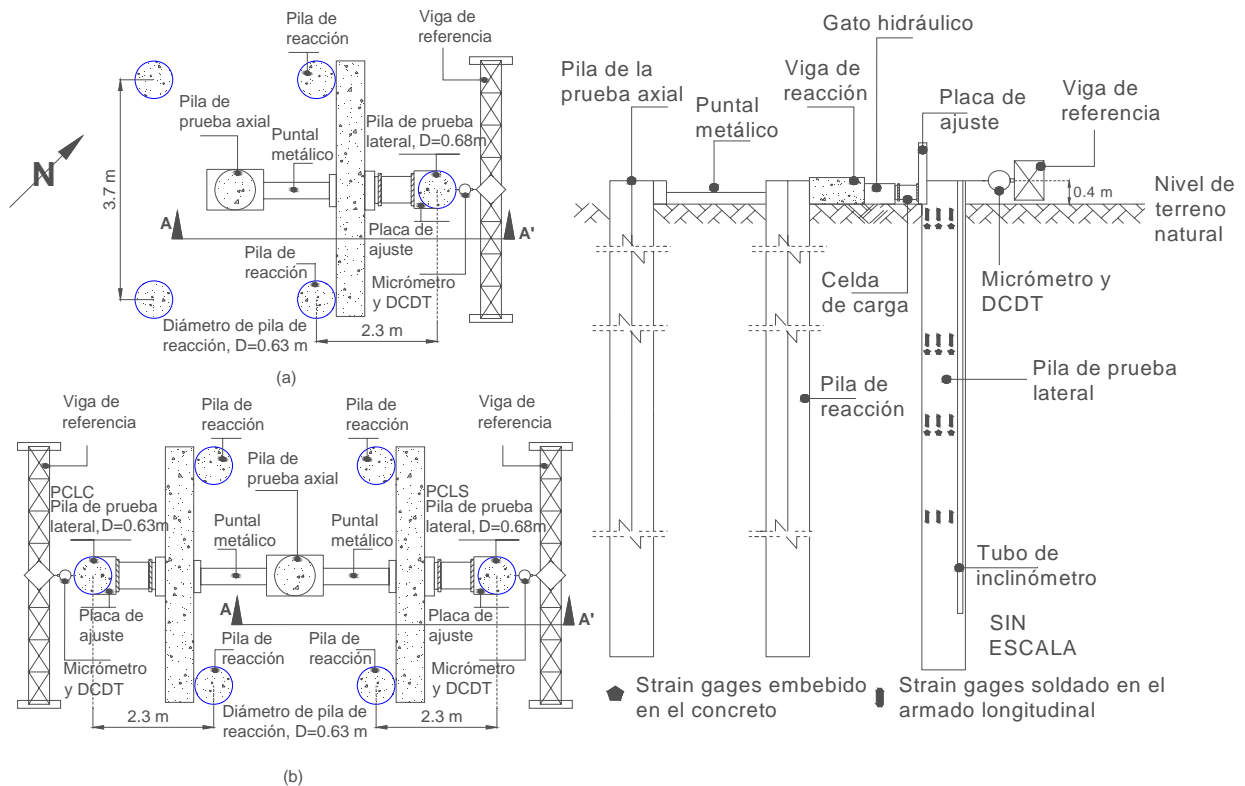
Arreglo para llevar a cabo la prueba de carga lateral a) vista en planta Sitio Periférico, b) vista en planta sitio San Antonio y c) corte A – A'
